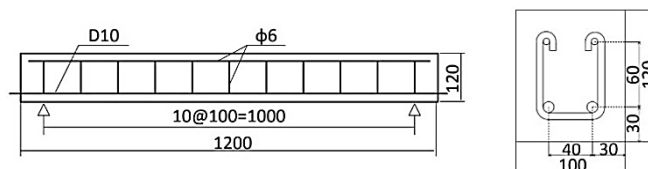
RC 梁試験体の寸法および配筋図（単位：mm）
